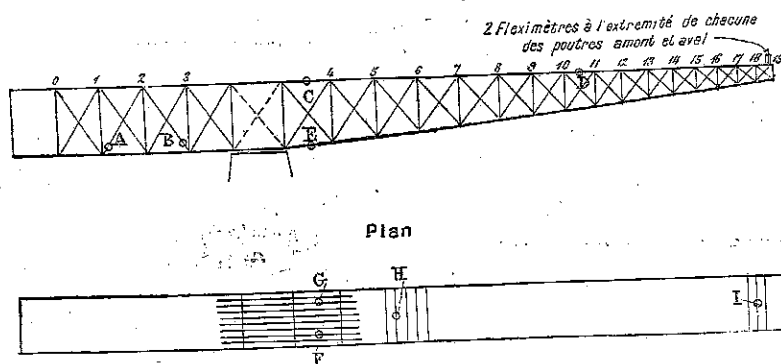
Schéma d'une volée donnant les sections observées au cours des essais.
